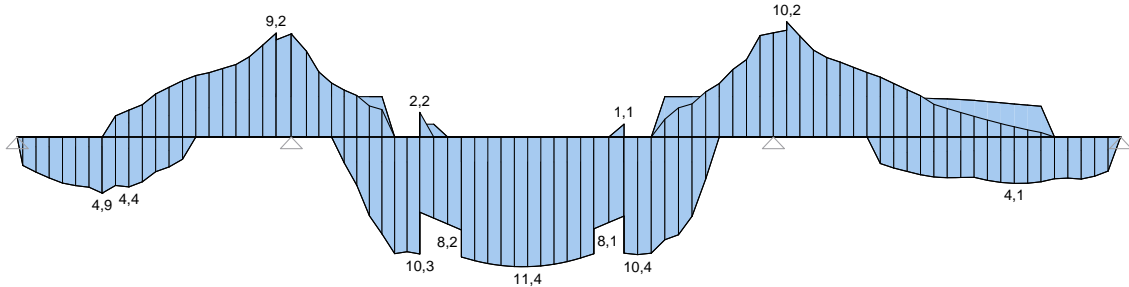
Erforderliche Längsbewehrung (inkl. äußerer Lagen der Öffnungsgurte). Maßstab 1 : 100, 1cm = 6,67cm<sup>2</sup>.
